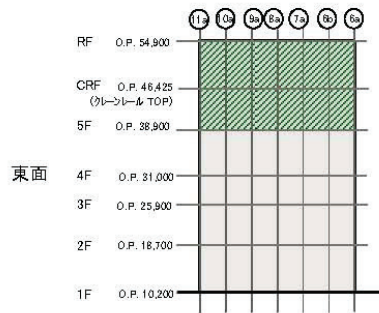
1号機原子炉建屋の損傷状況（立面図）
